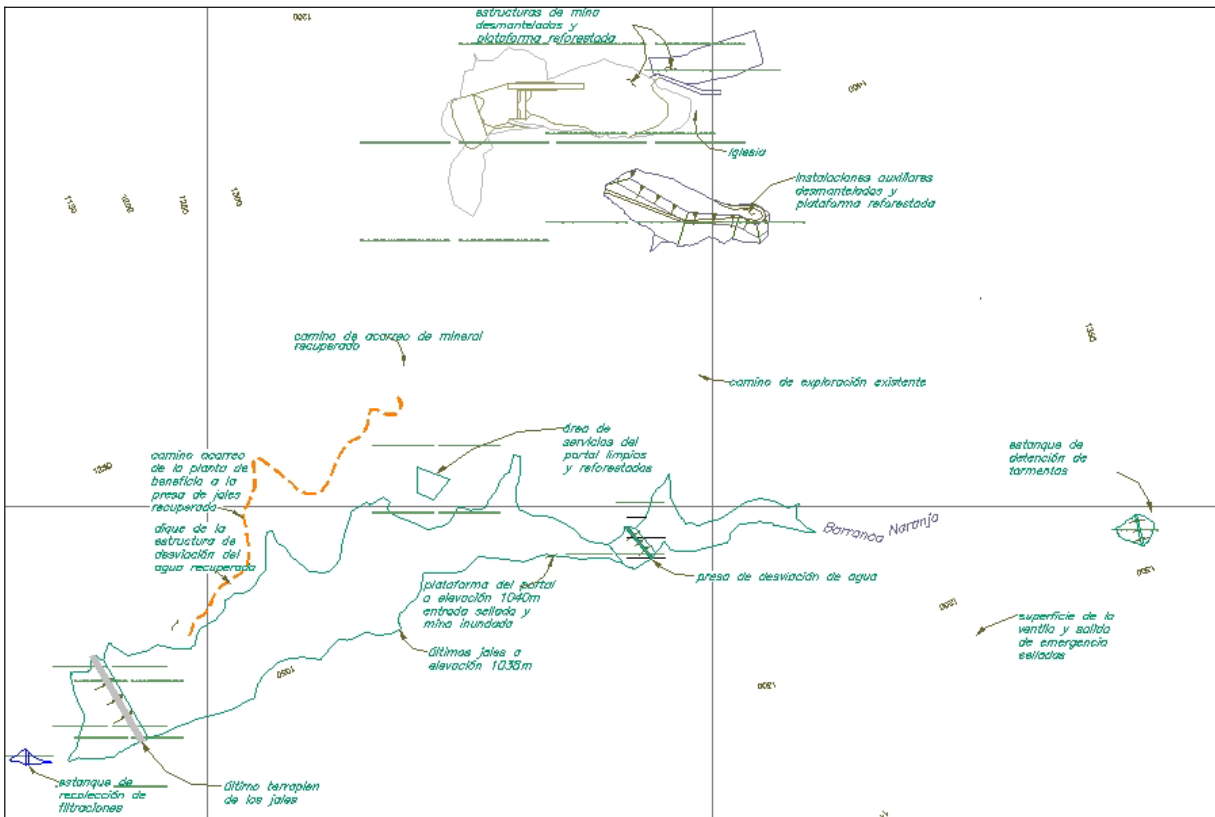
Plano B34 que muestra el plan de cierre del proyecto.
